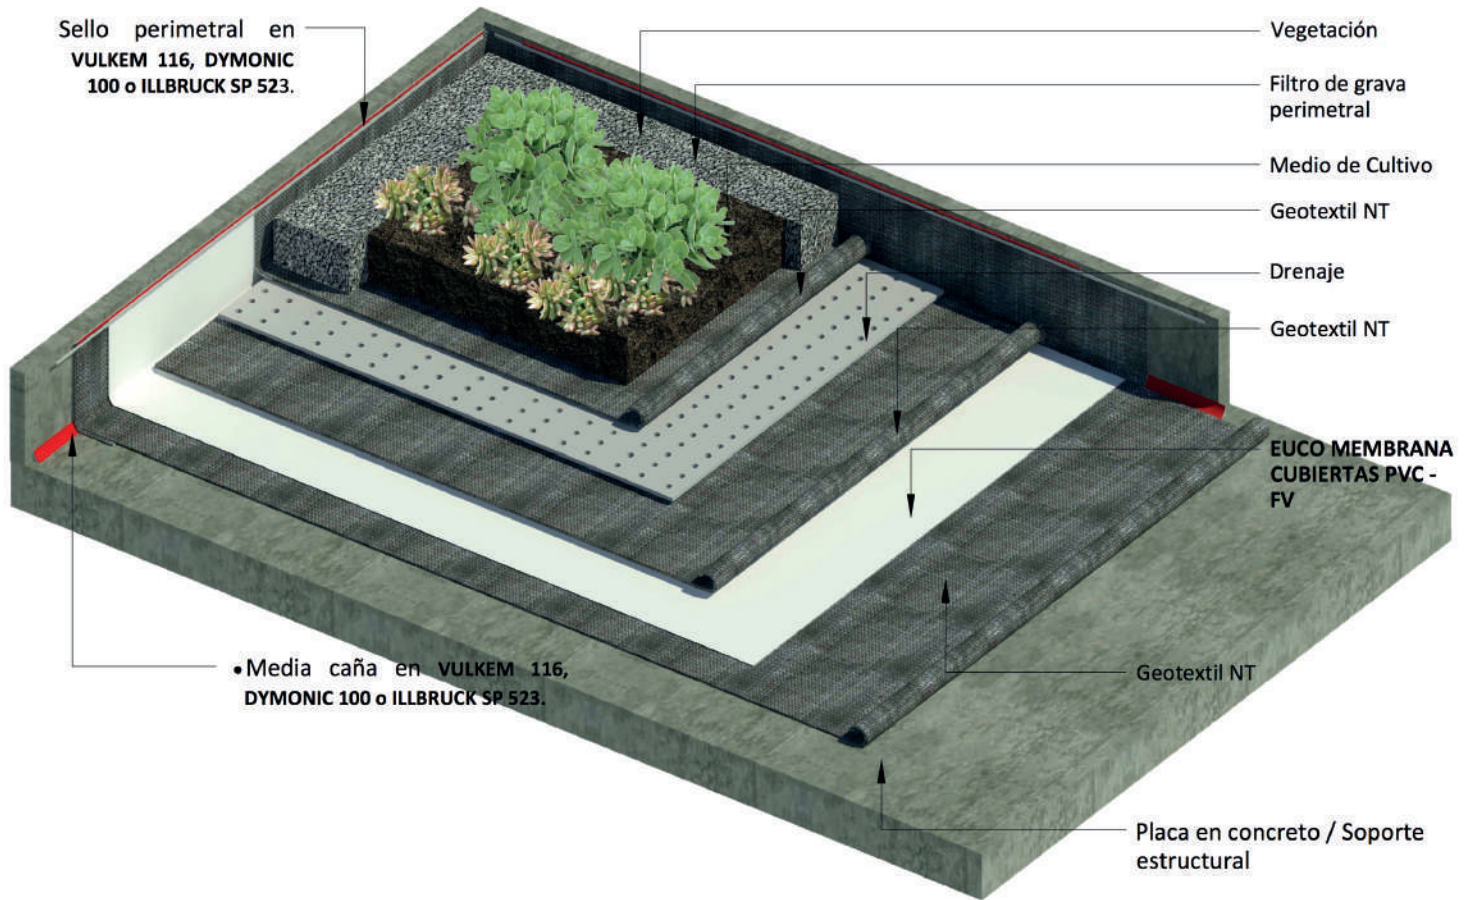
Sistema techo vegetal e impermeabilización con EUCO MEMBRANA CUBIERTAS PVC - FV.
